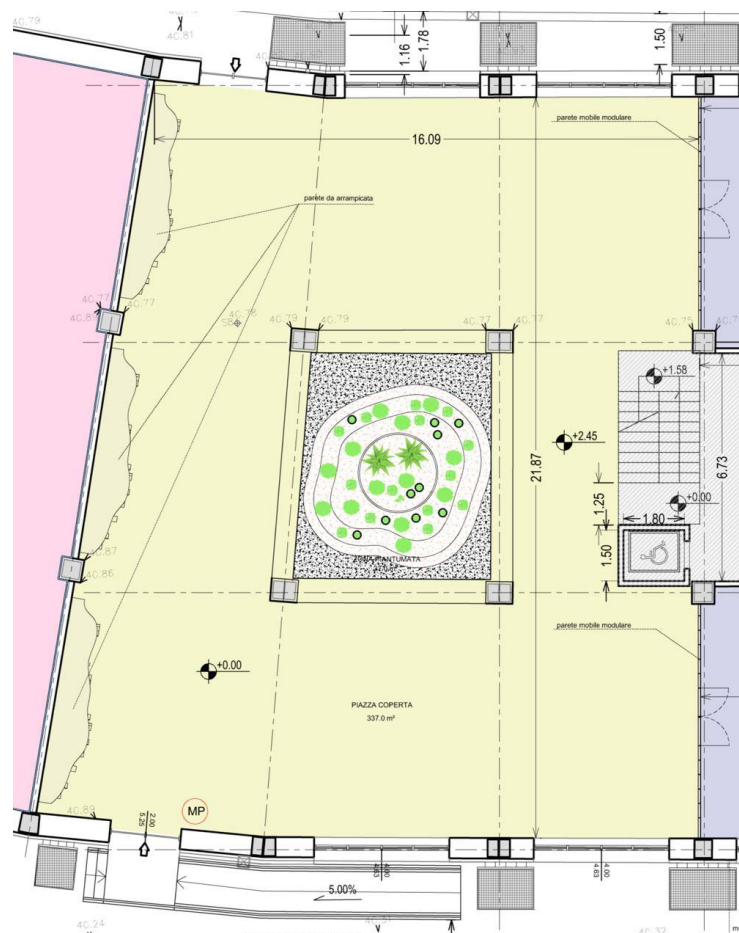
Stralcio Planimetrico della nuova piazza coperta
